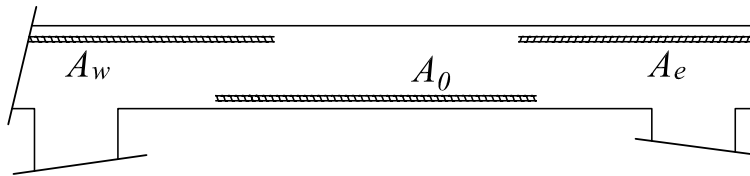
Forme du ferrailage à adopter dans une poutre continue
